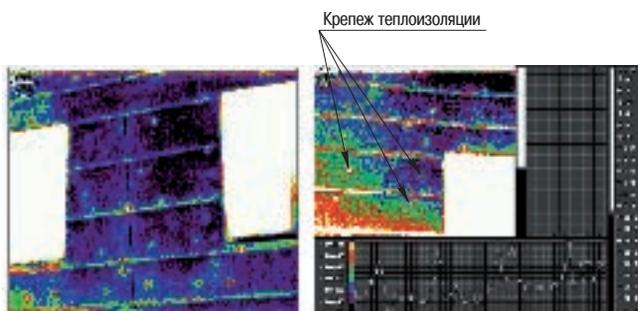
Термограммы утепленных фасадов (теплоизоляция закреплена дюбелями со стальным распорным элементом)
